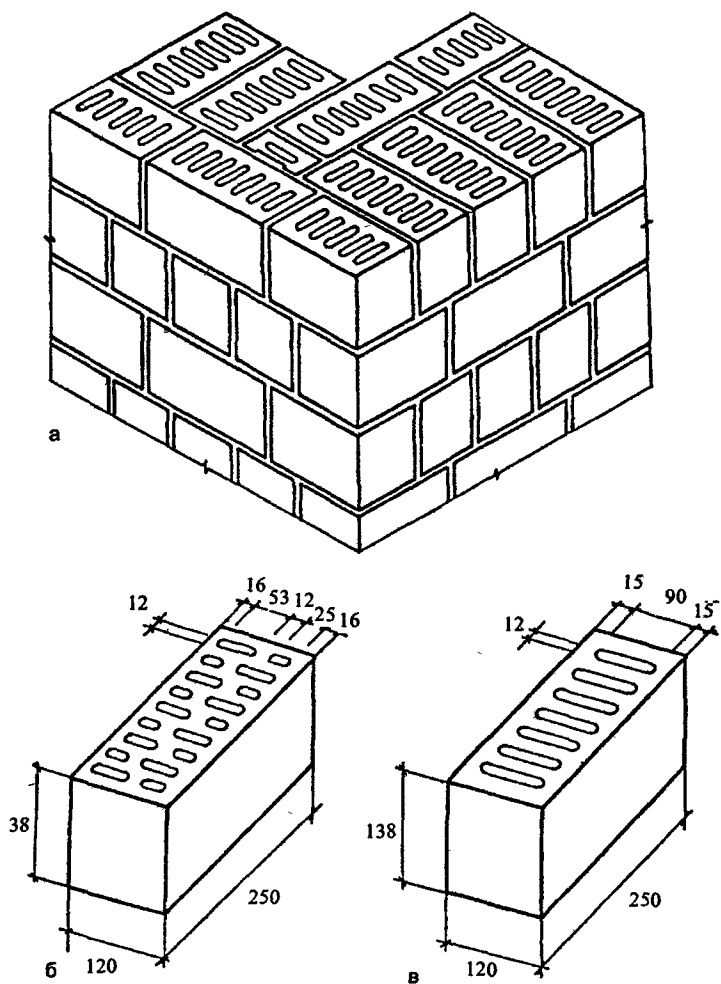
Фрагмент стены из пустотелых керамических камней:
